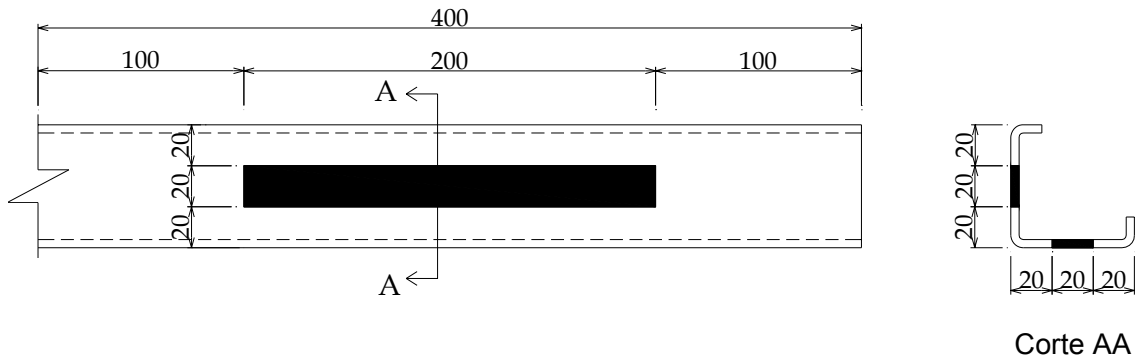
Localização dos corpos-de-prova na barra: perfil Le 60x15x2,00 (dimensões em mm)
